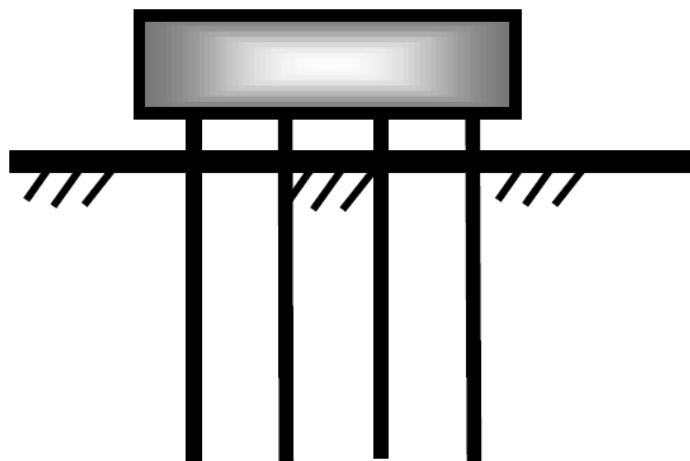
Схема фундамента с высоким свайным ростверком
